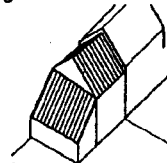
bâtiment secondaire en appentis au mur-pignon
